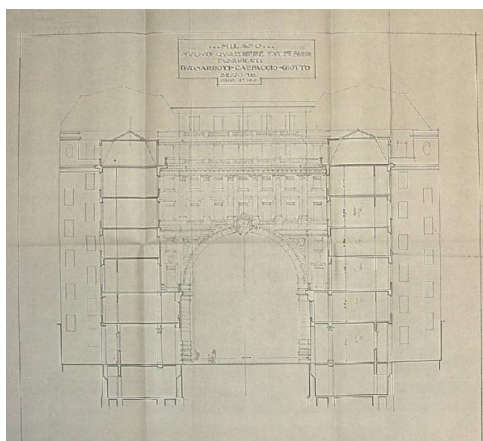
Prospetto e sezione su via Salvini (Archivio Civico Milano, Edilizia Privata)
